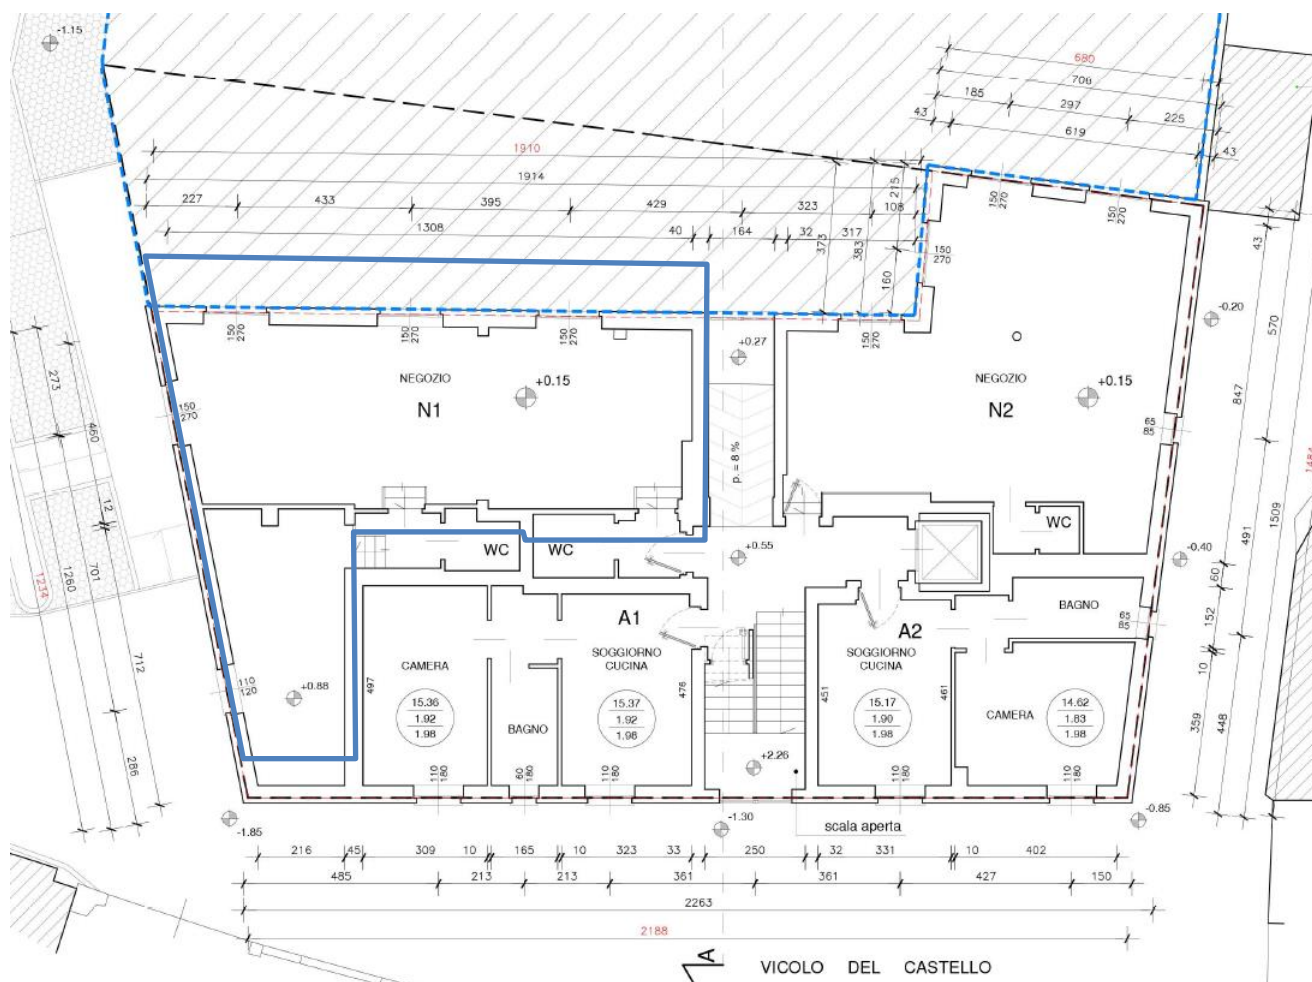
ESTRATTO PIANTA PIANO TERRENO SCIA N. 5709 DEL 2019
